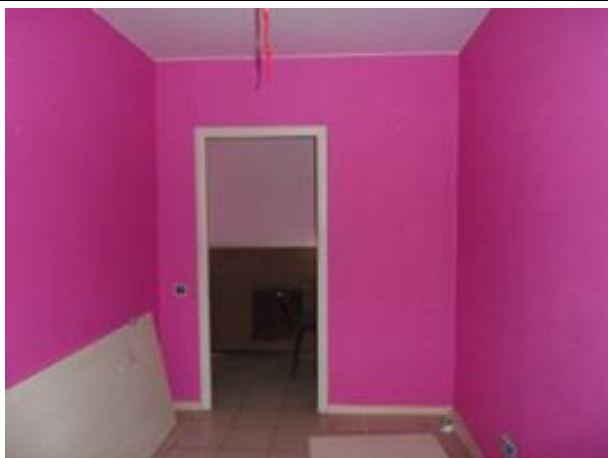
Часть помещения №6 помещения 6-Н, вид на вход из части помещения №4
